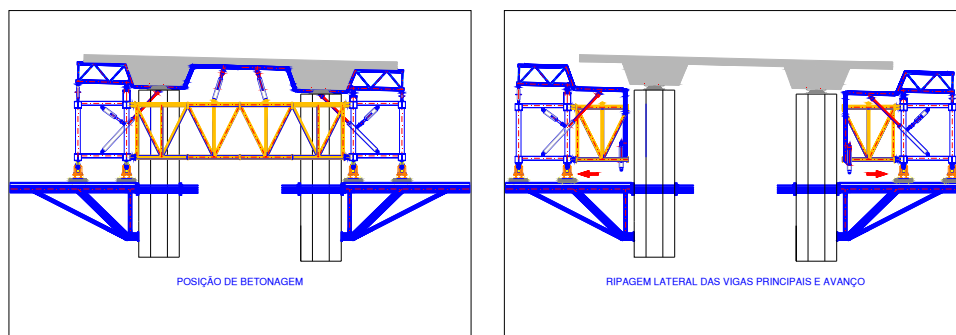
e 9 – Cembre inferior em betonagem(esq) e em avanço(dir)
